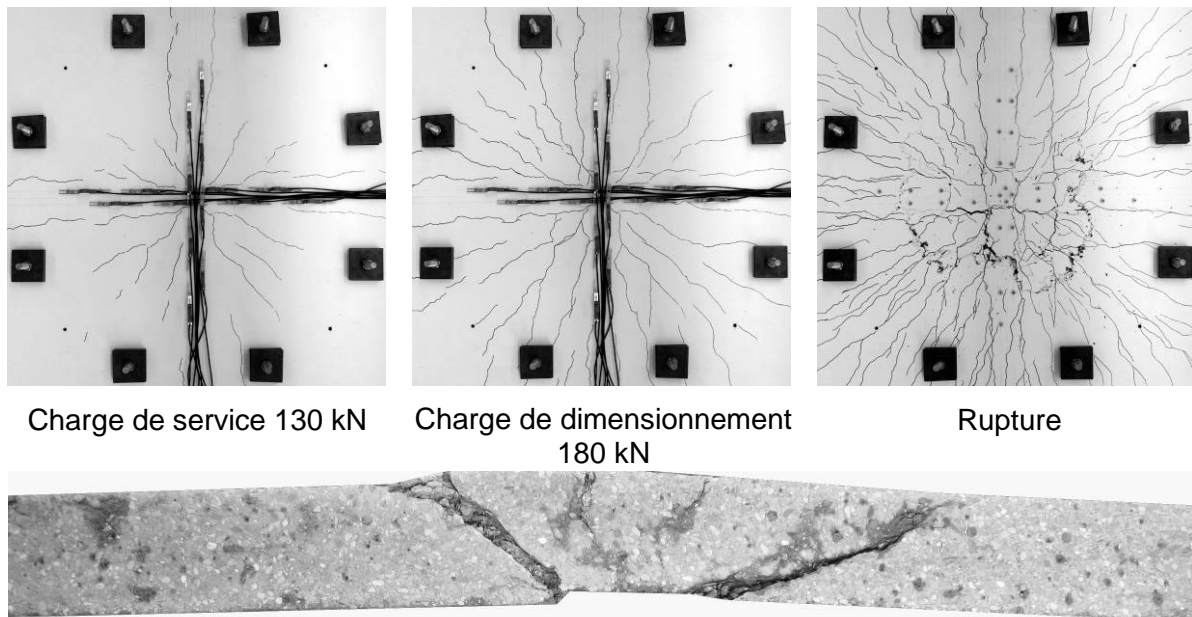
Fissuration à plusieurs niveaux de charge et fissures internes de la dalle B5-01.
